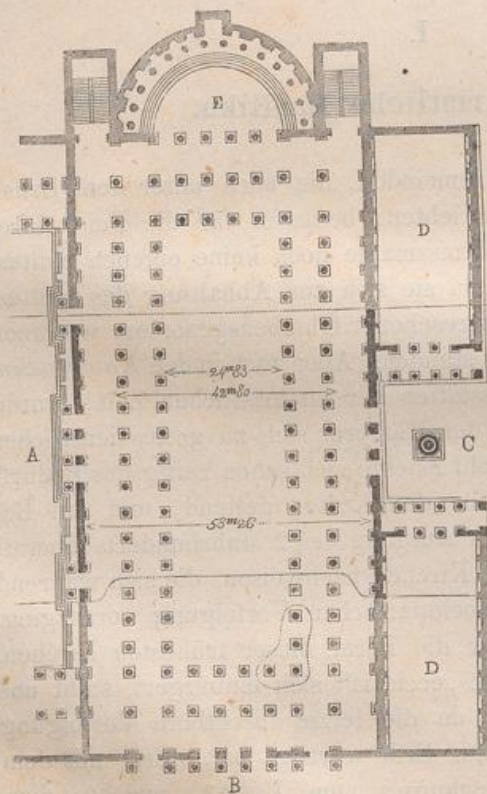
Grundriss der Basilika Ulpia.
